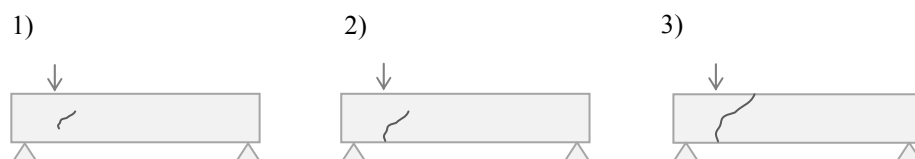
Esquema de fissura: evolució d'una fissura de tallant.
